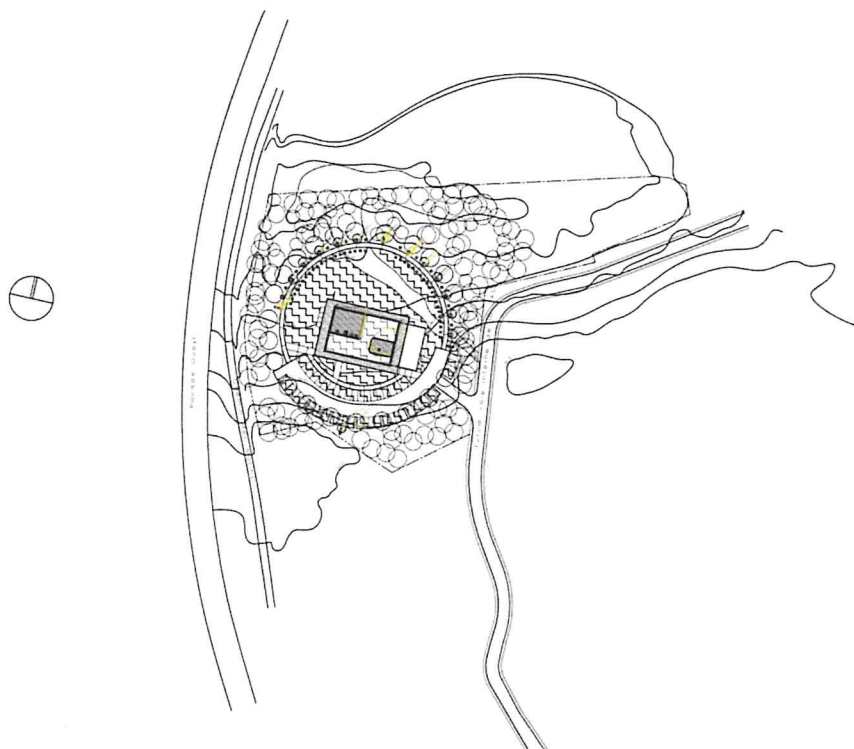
Plan du projet de construction d'un ensemble funéraire.
